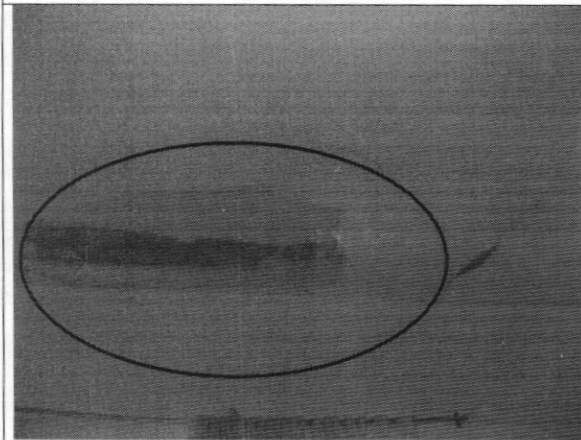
Humedad y deterioro en cielo raso bajo la cubierta
